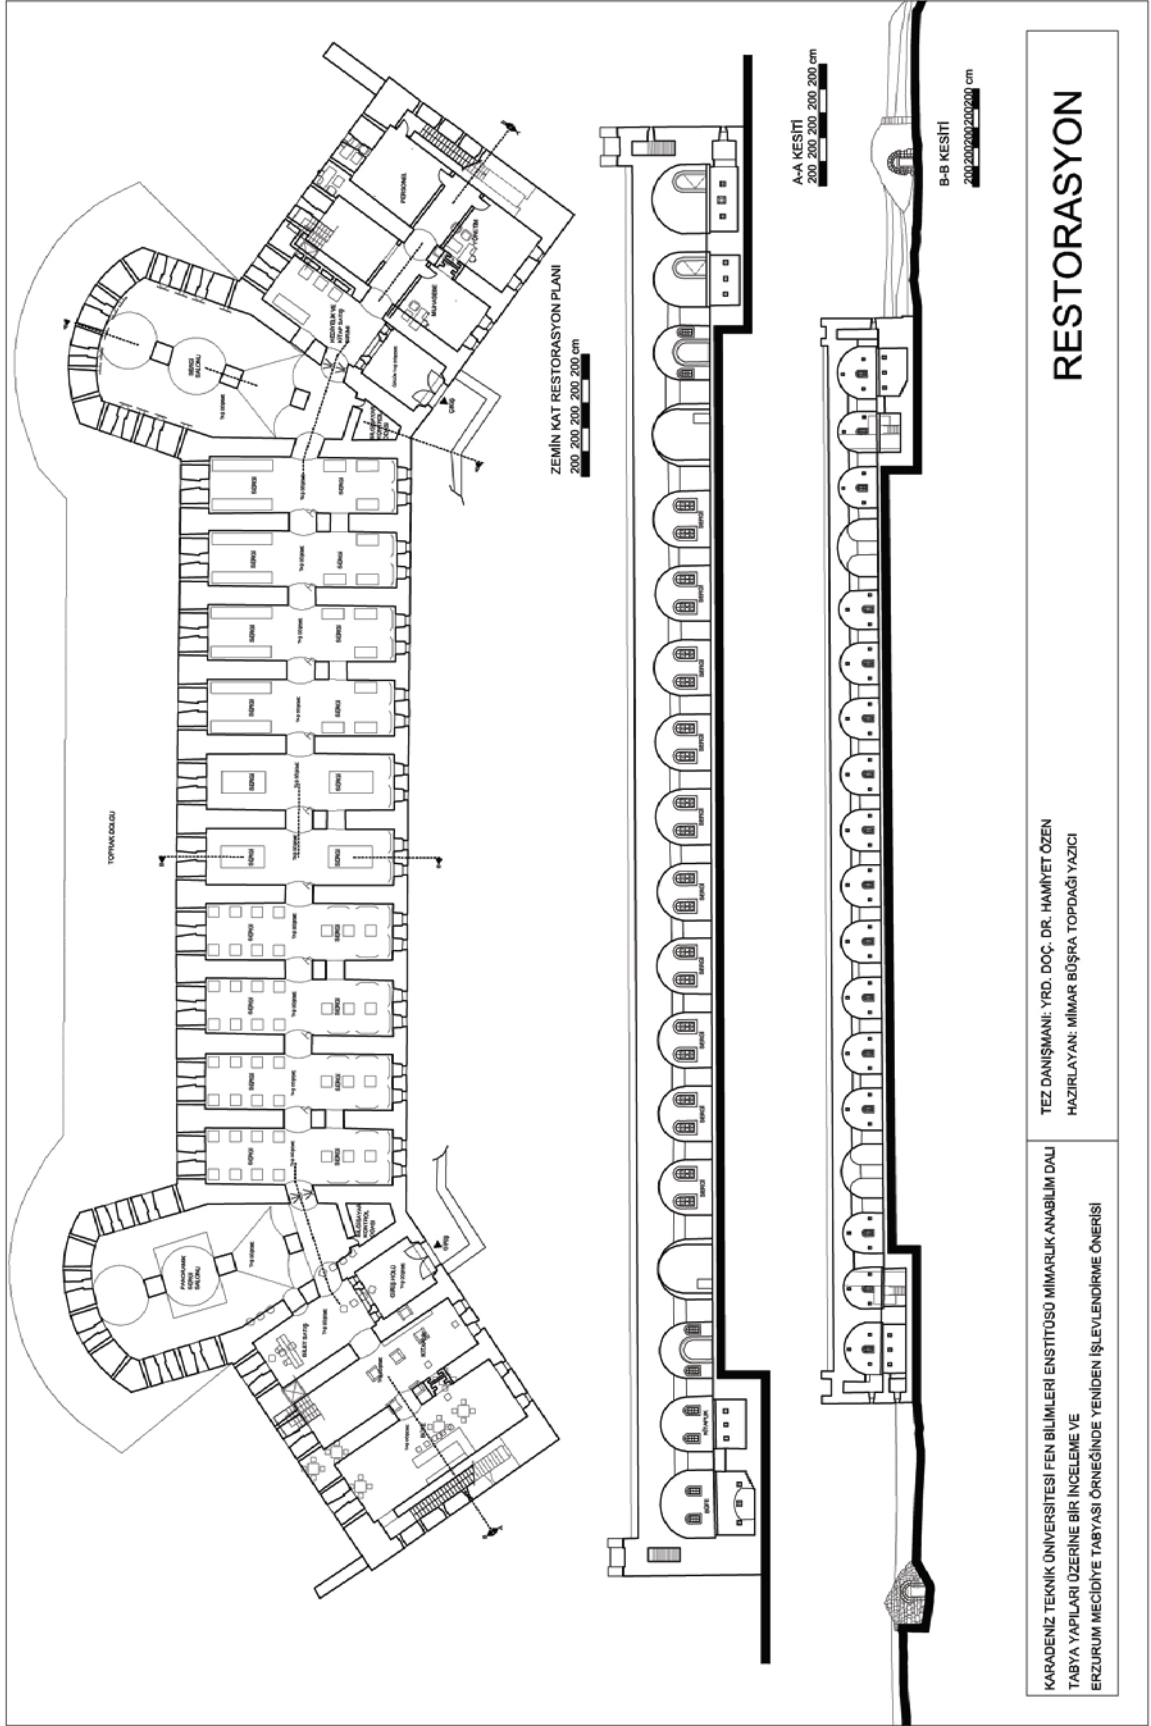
Zemin kat planı ve kesitlerde müdahale analizi
